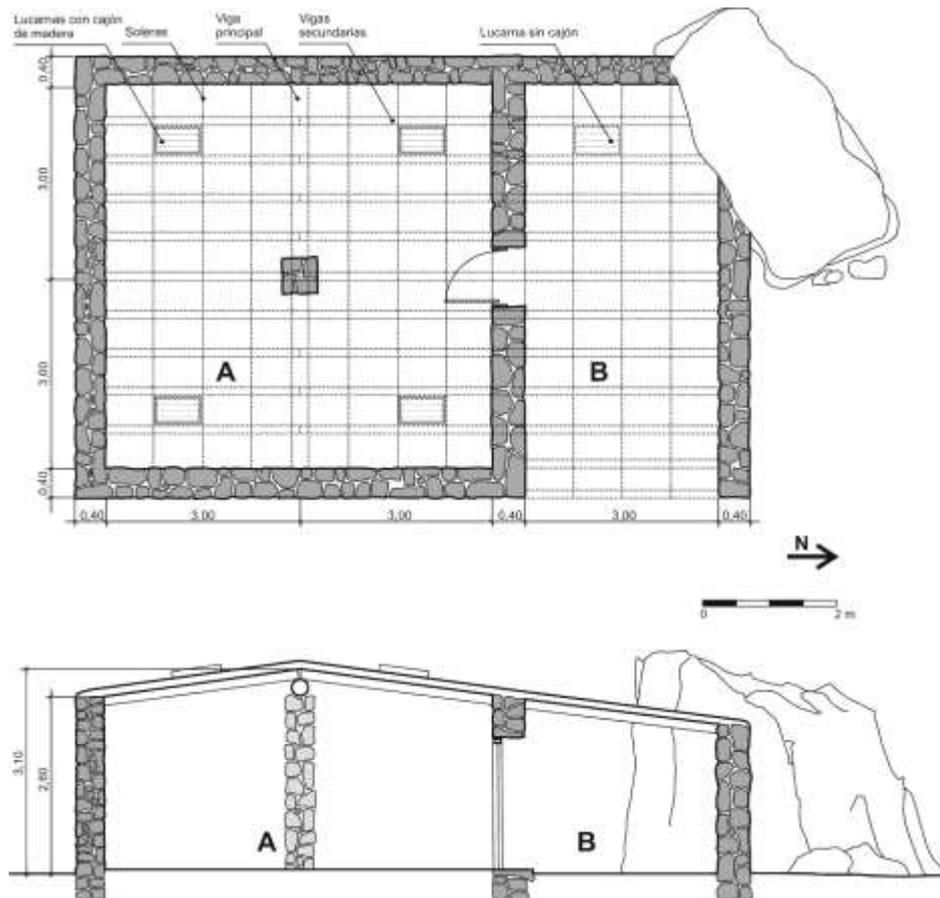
Planta y corte del CIPP tal cual fue construido (Realización propia en base a los planos del proyecto provistos por el Lic. Aschero)
